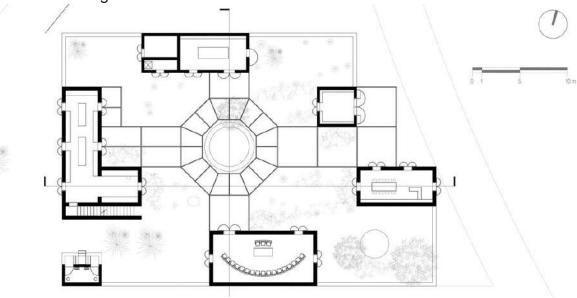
Planta arquitectónica del Centro Social "Las Margaritas" (Recuperada de archdaily).
